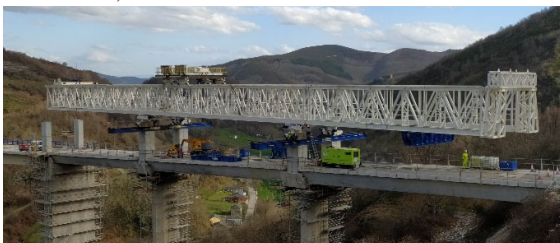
Vista del lanzador de vigas posicionado sobre el vano 8 de la estructura.
